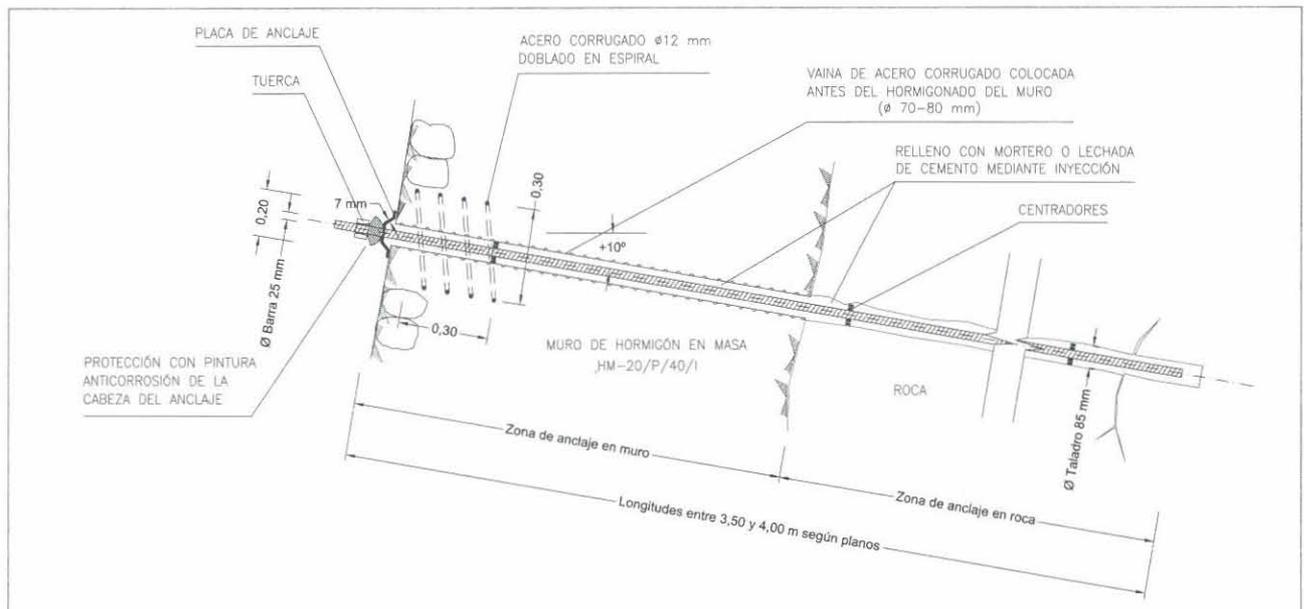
Detalle de anclaje pasivo adherente en base de cimentación de muros.
